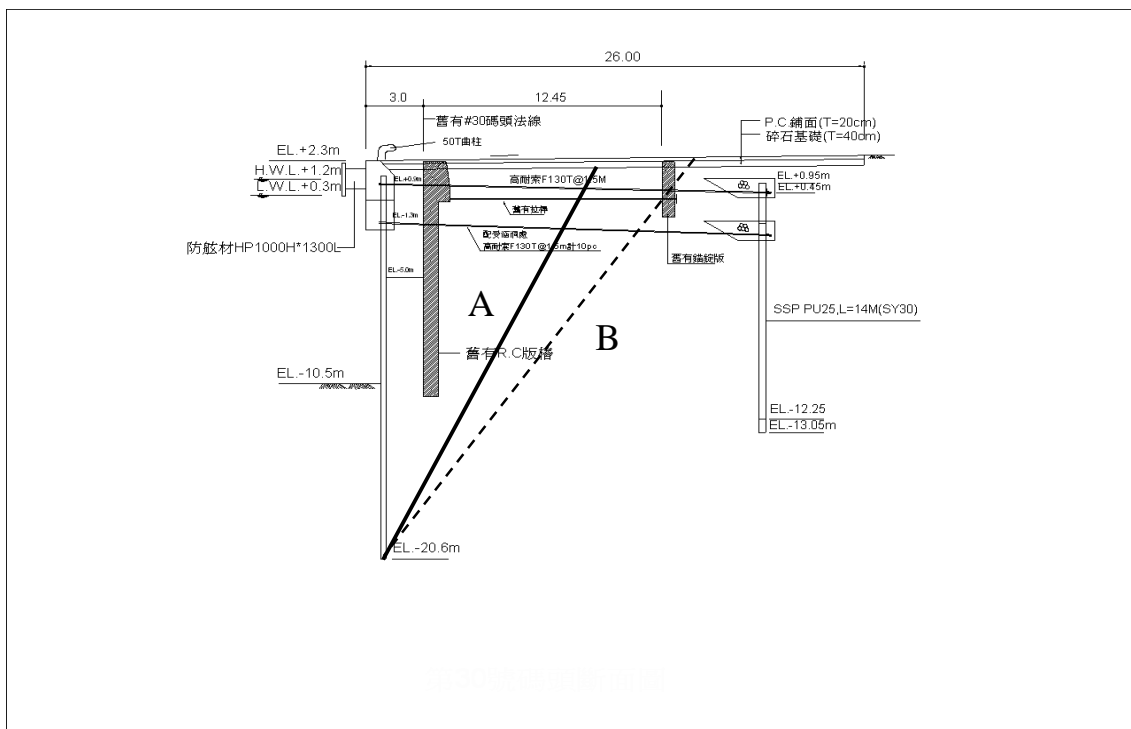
改建型板樁式碼頭主動破壞面示意圖
